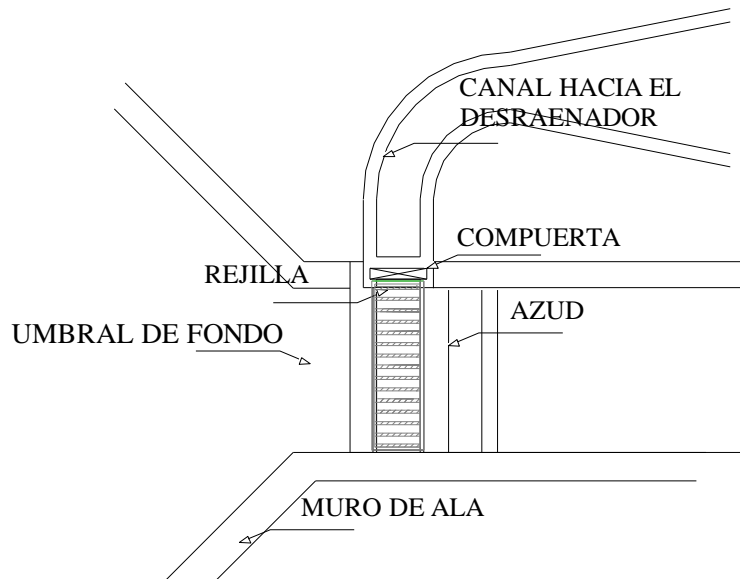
Partes de la toma de fondo vista en planta (Elaborado por Herrera Diego)
